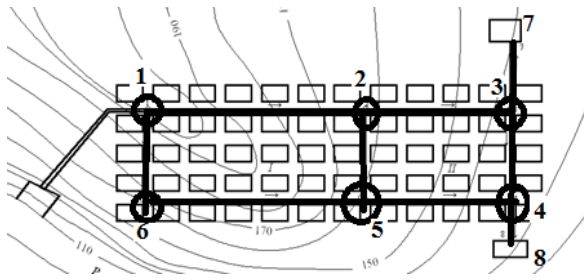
Расчетная схема сети (цифрами обозначены узлы: 1...6; отдельно
